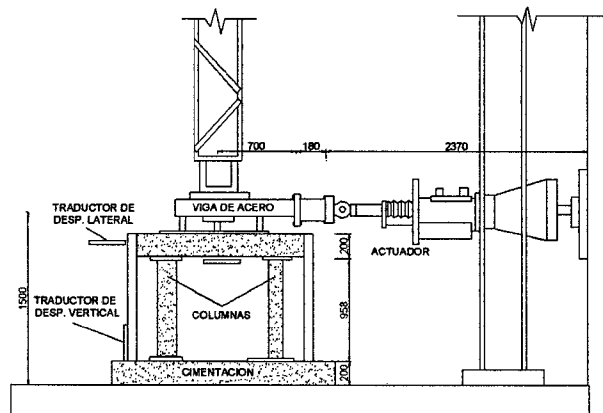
Ensayo On-Line De Carga Biaxial En Un Pórtico De Concreto Reforzado.
